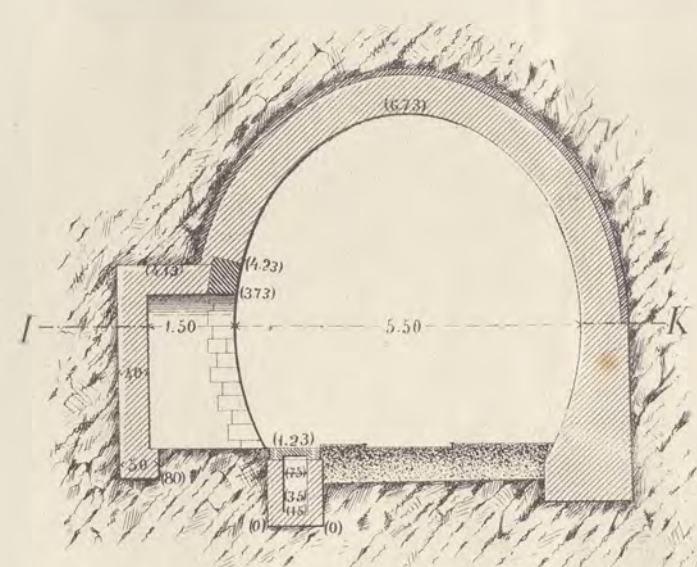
<sup>a</sup> Sezione verticale passante per gli assi di un pozzo e della corrispondente piccola galleria trasversale e sezione orizzontale NO.
